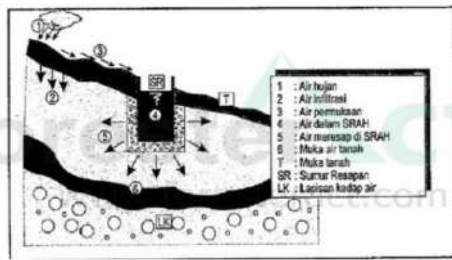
Contoh Desain Drainase dengan Bahan Batu Bata dan Beton
